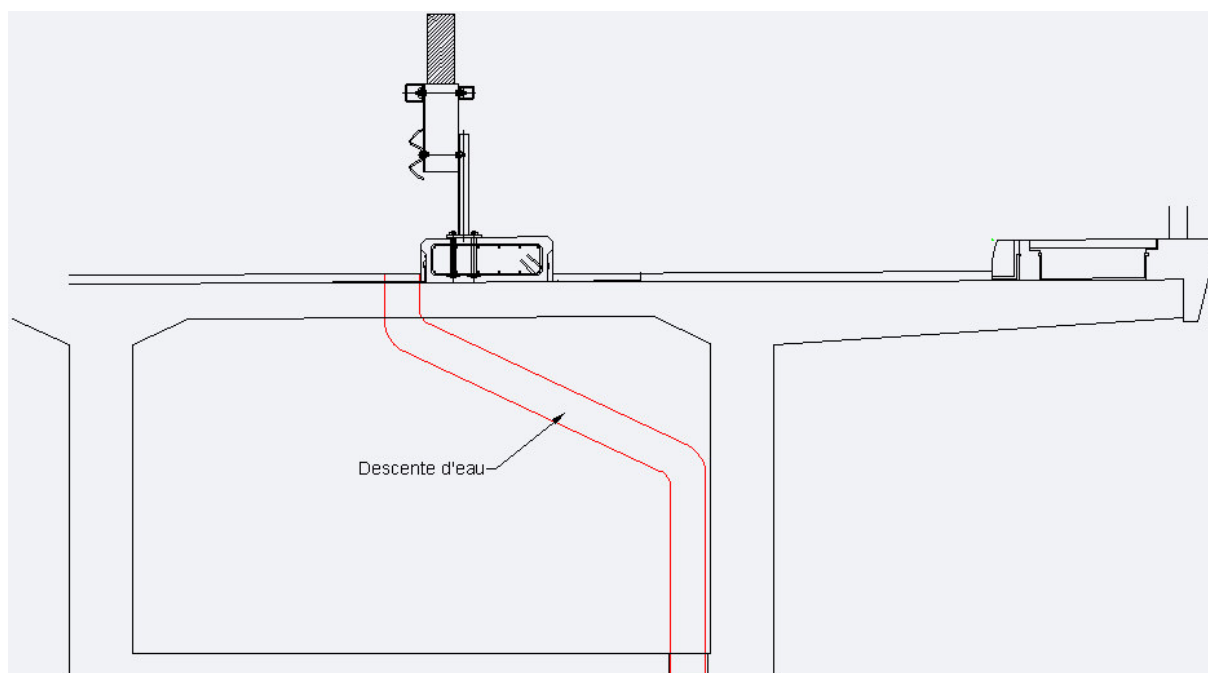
Coupe du caisson d'about avec sa descente d'eau.
